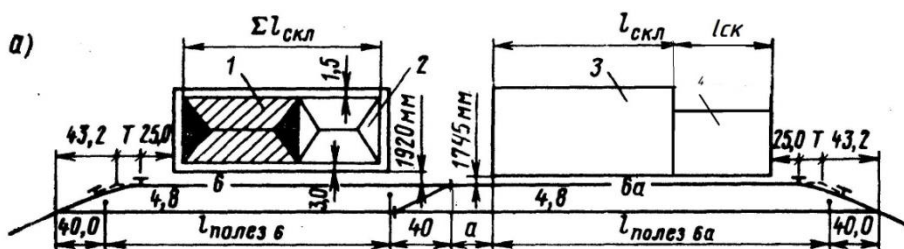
Схема размещения грузовых устройств на неопорной промежуточной станции: 1-крытый склад, 2-крытая платформа, 3-контейнерная площадка, 4- навалочная площадка
